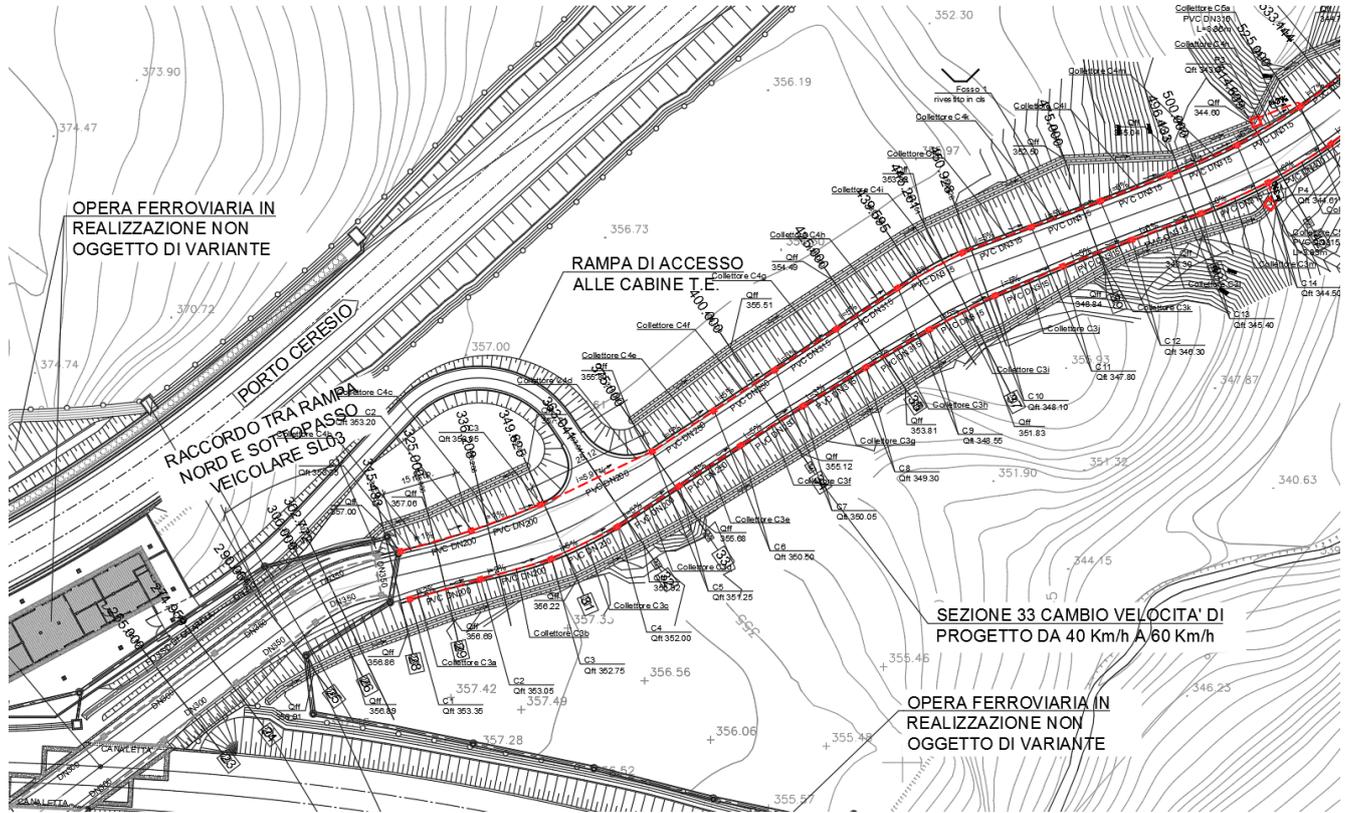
Planimetria di smaltimento idraulico Rampa nord
